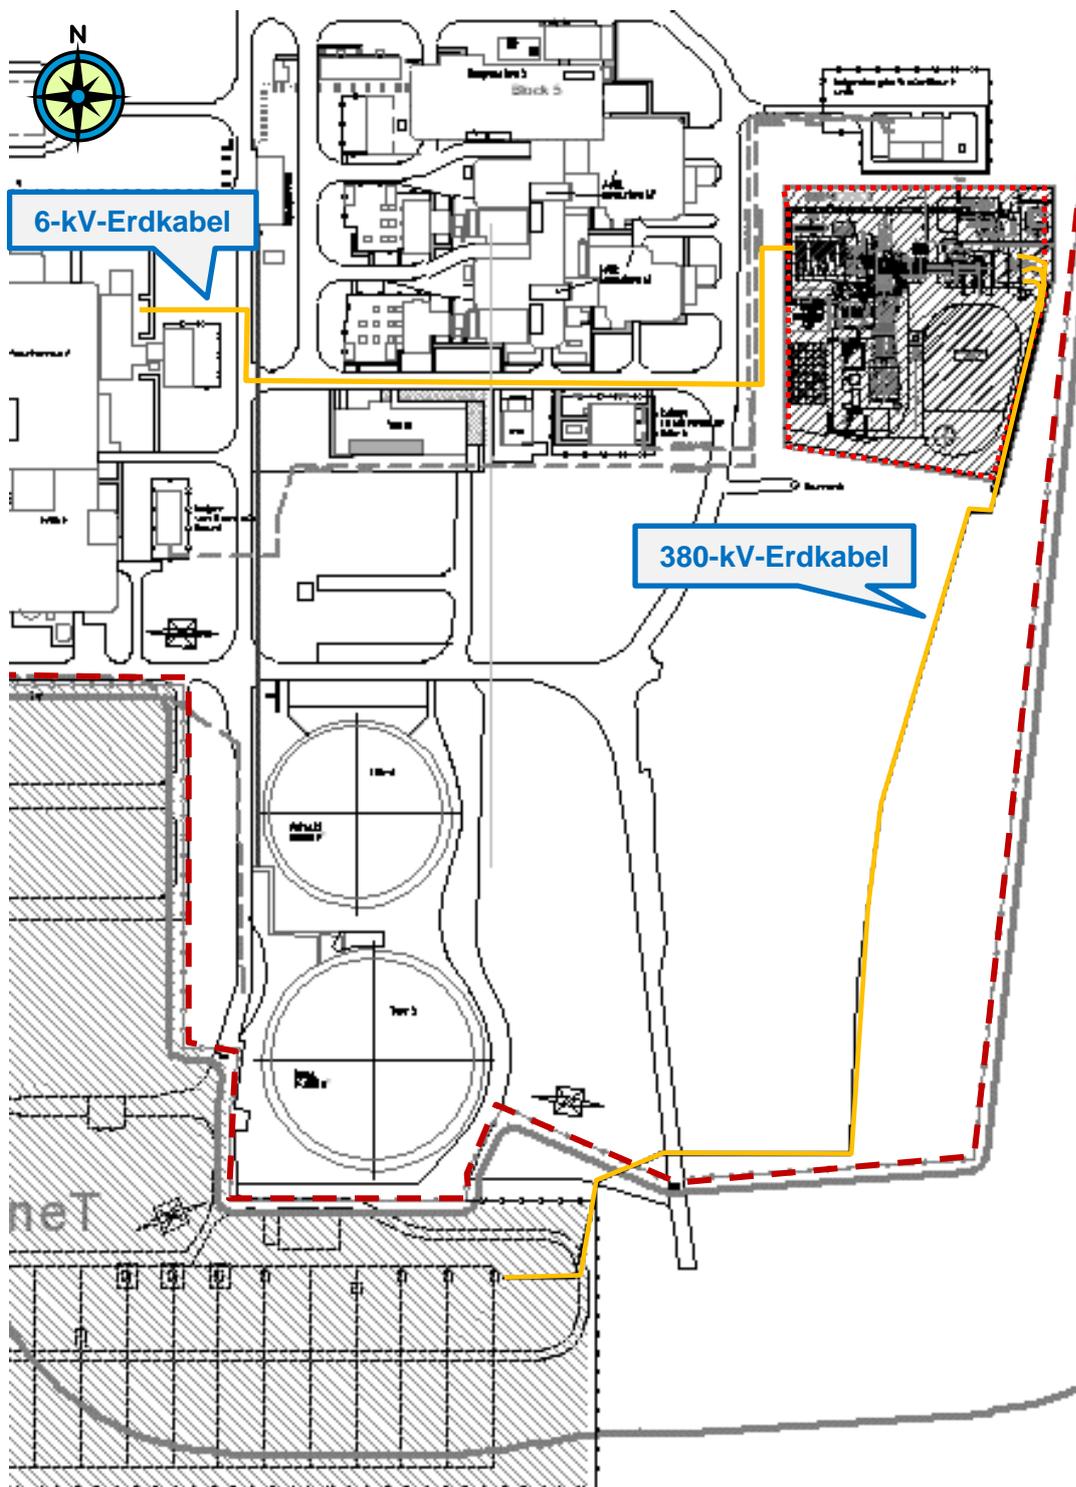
Lageplan des geplanten Block 6 im Kraftwerk Irsching mit Start- und Endpunkt der Erdkabel (orange) sowie der Anlagenbegrenzung des Neubaus (rot gepunktete Linie) und Grenze des Betriebsgeländes (dunkelrot gestrichelte Linie).
